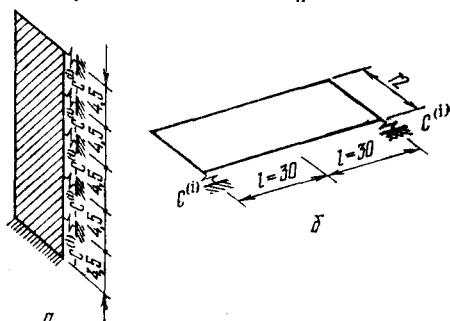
Расчетные схемы вертикальных (а) и горизонтальных (б) элементов здания.
